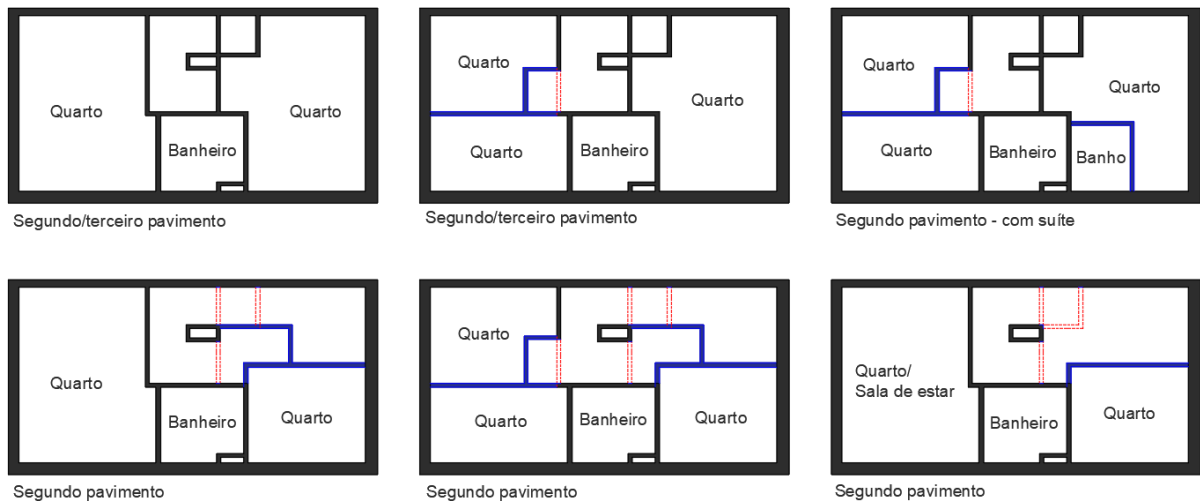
Módulo para o segundo pavimento de casas com entrada lateral e alterações – Empresa C
